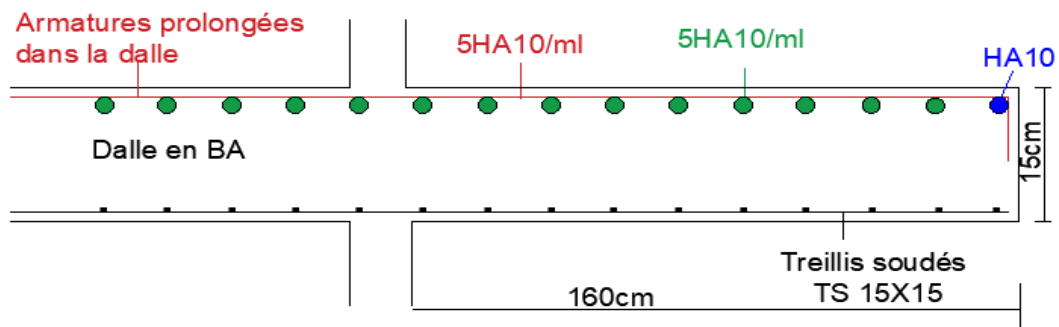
Coupe de schéma de ferrailage du balcon selon l'EC2.
